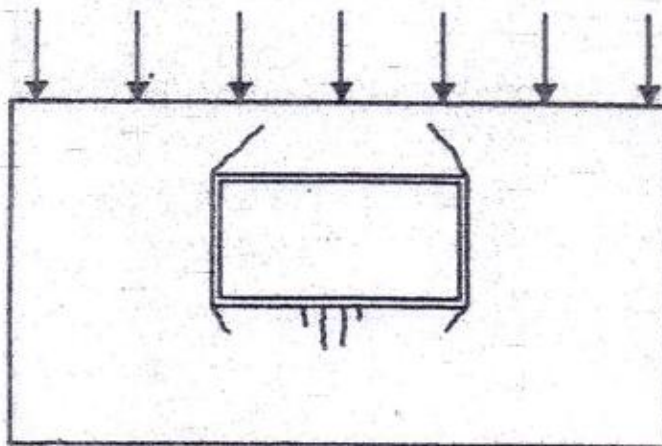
Fissuração teórica no encontro de abertura em parede solicitada por carga vertical
